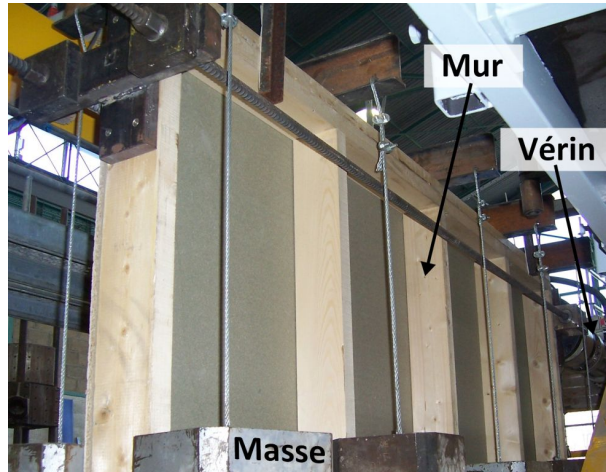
Mur de contreventement sur le banc d'essais (CSTB)
